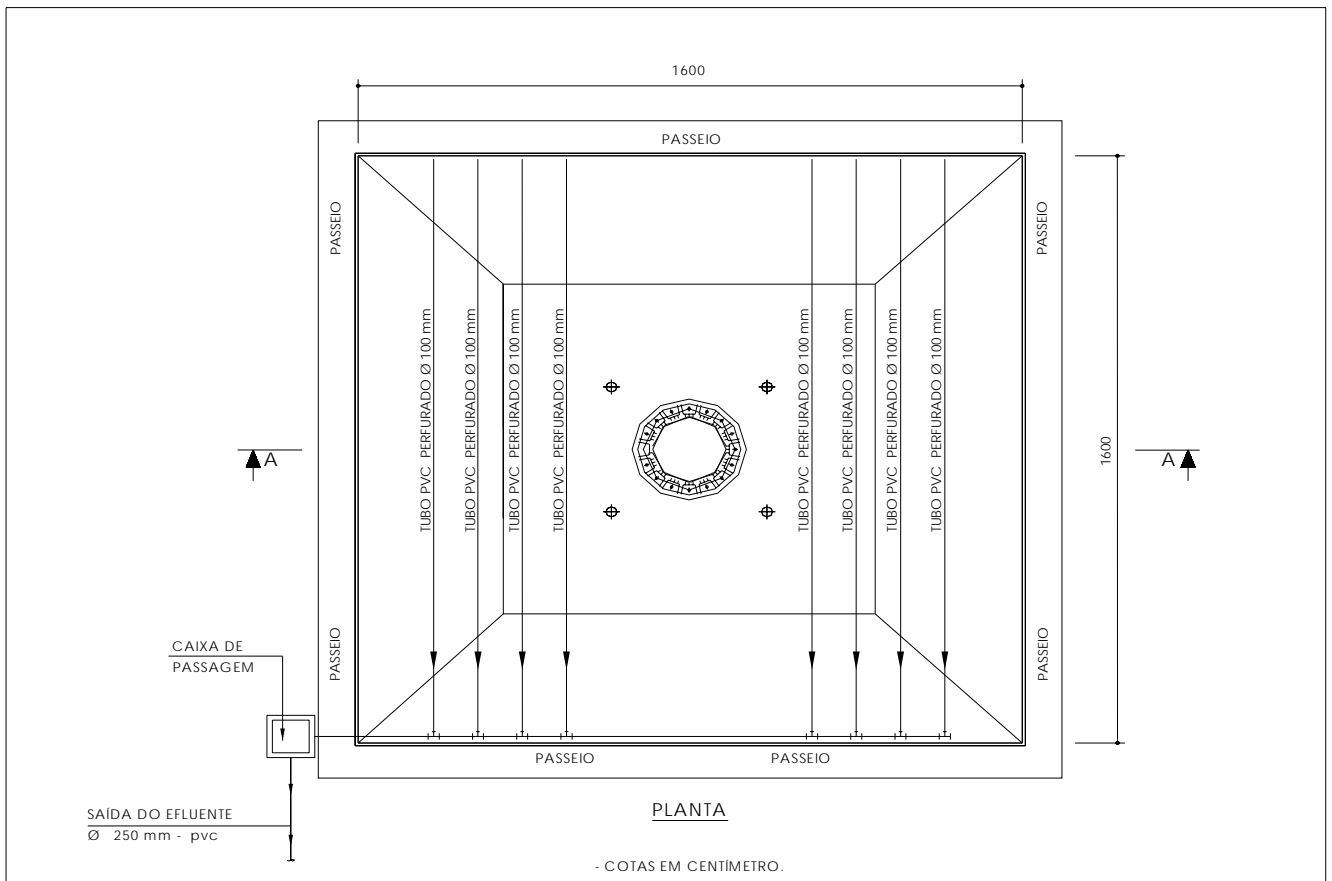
Planta baixa nível superior do filtro anaeróbio proposto
